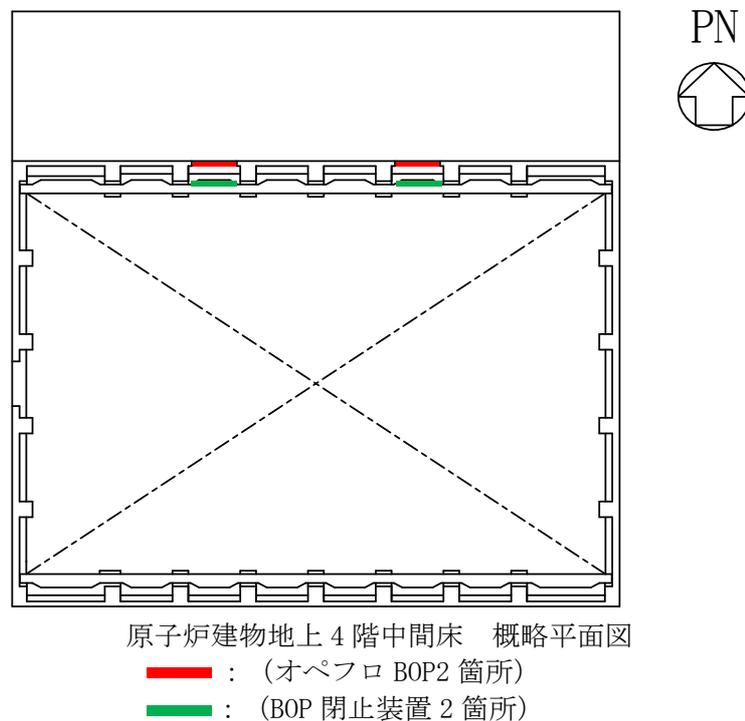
原子炉建物原子炉棟地上4階 概略平面図
